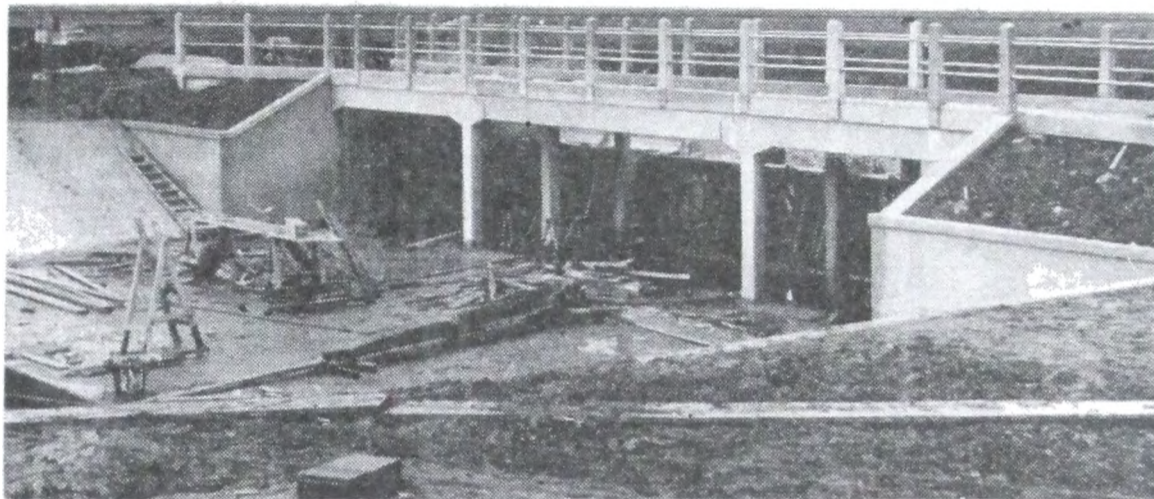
Canal de Guido al mar. Puente compuerta en el Km. 6,5.
